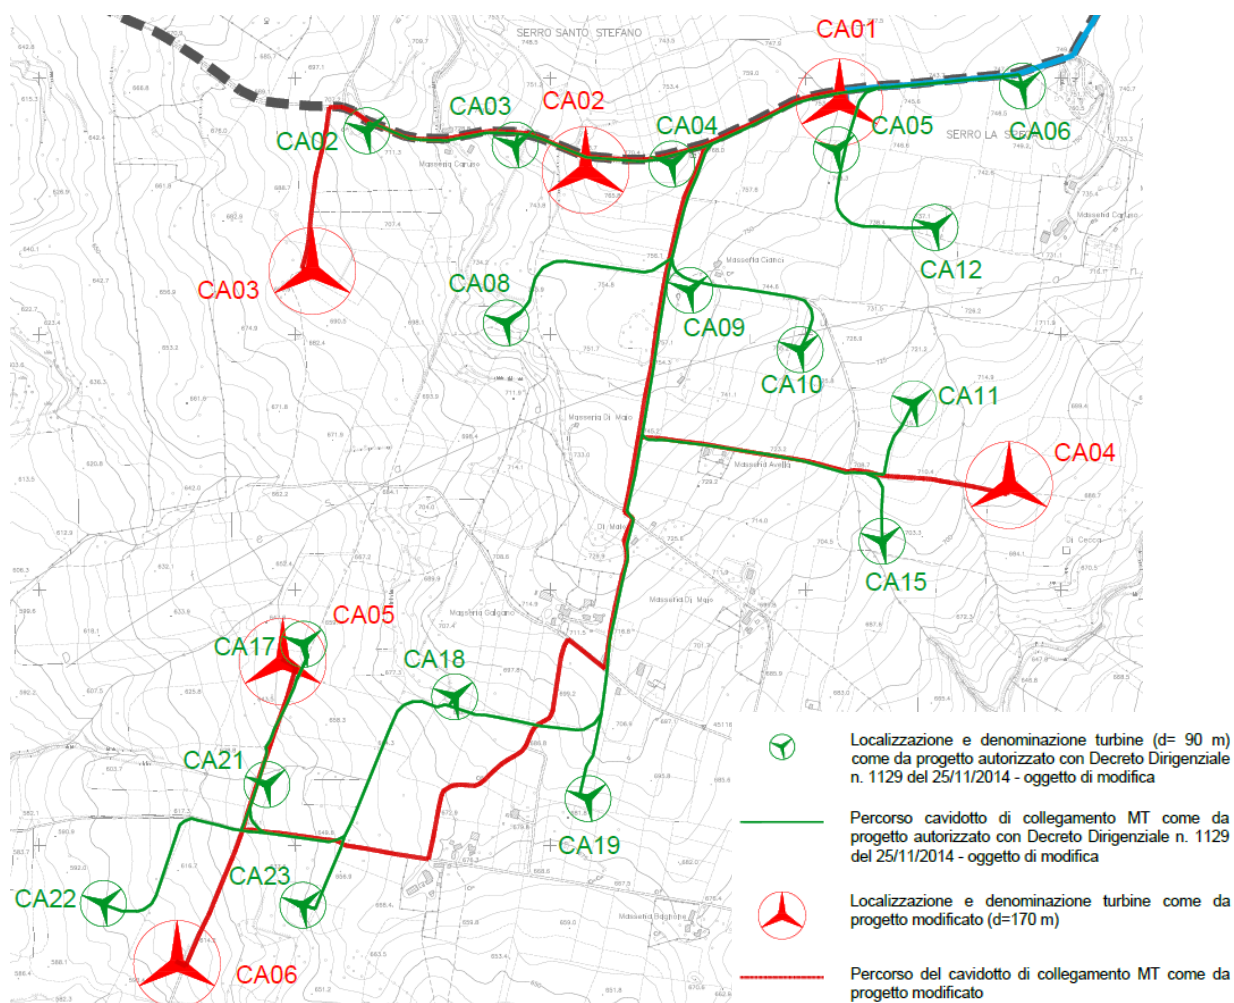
Confronto layout impianto autorizzato e layout come modificato.
